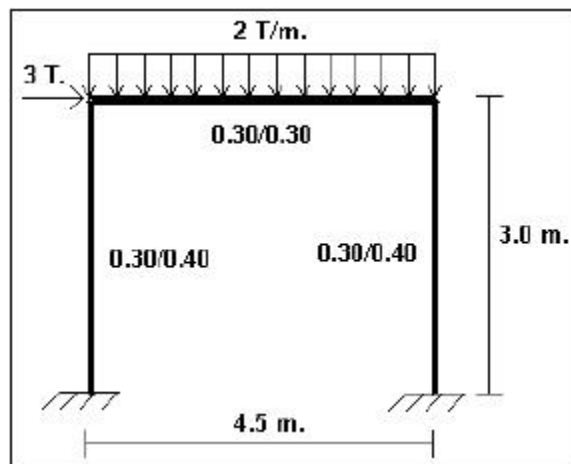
Pórtico plano a resolver con CEINCI-LAB
